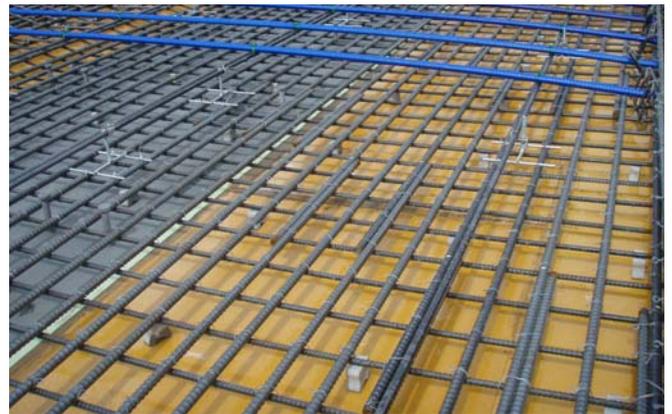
床版配筋状況（下側組立鉄筋使用なし）
